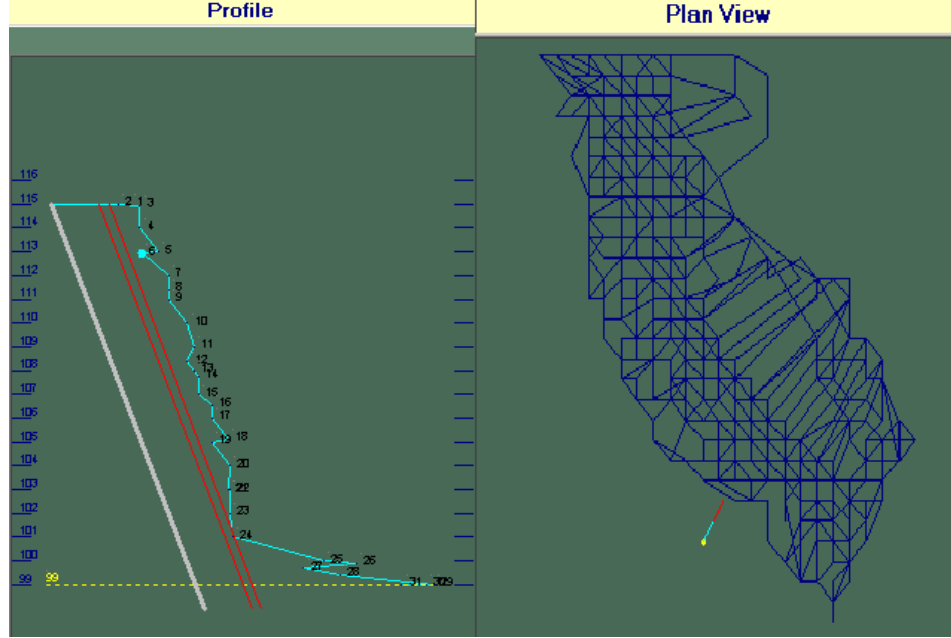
Ömerli sahası delik profili ve plan görünümü (aynanın sol kısmı 1. delik)
